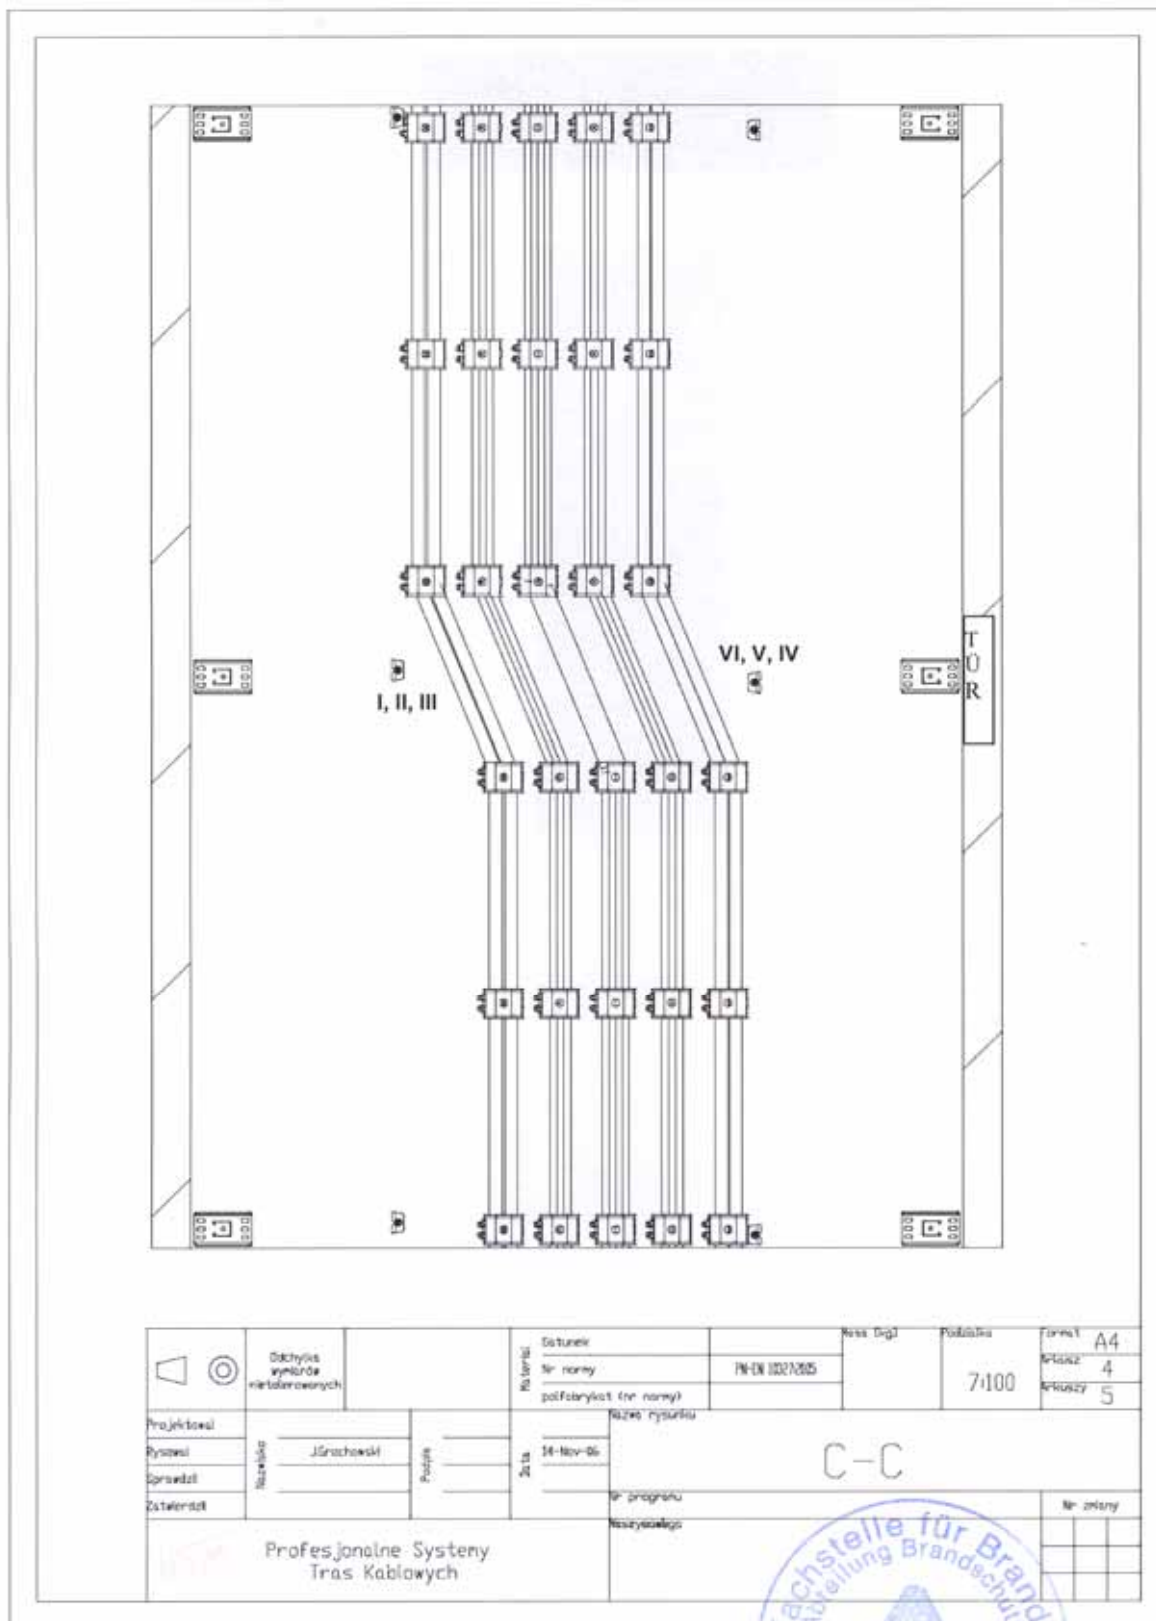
Lage der Thermoelemente im Grundriss
